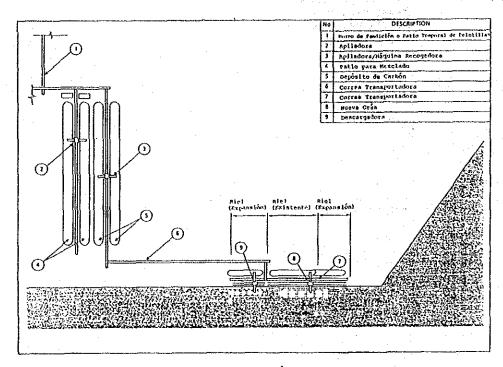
Plan General de Expansión del Atracadero SICARTSA, (Puerto Lázaro Cárdenas)
